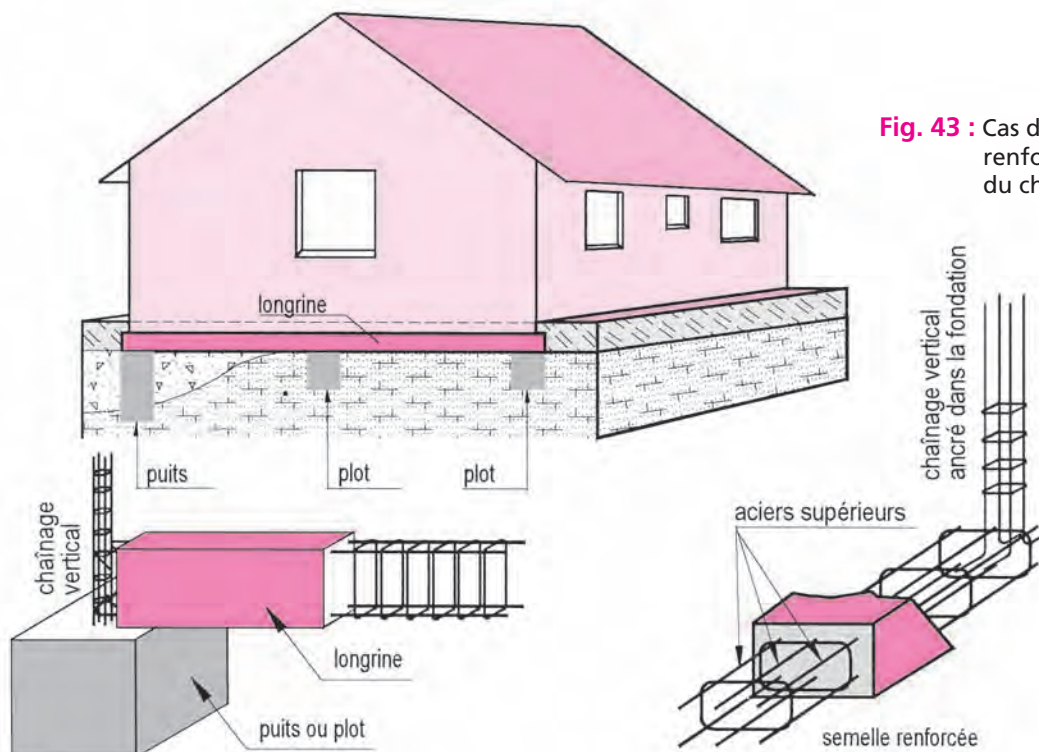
Fondation sur puits ou plot, longrine et chaînage vertical
